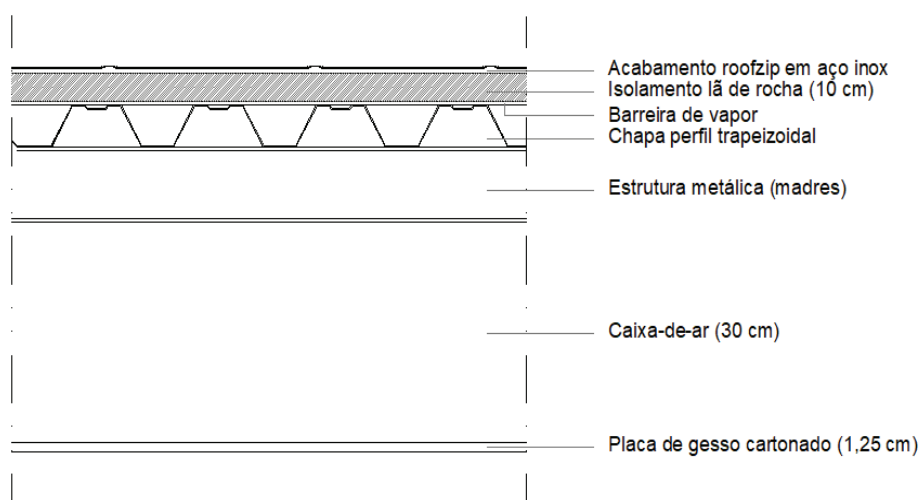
Pormenor construtivo da Cobertura tipo I (*open-space*)
